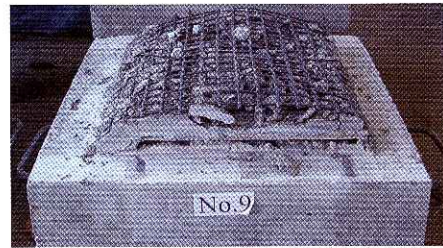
定着破壊状況（試験体 No.9:溶接金網）
